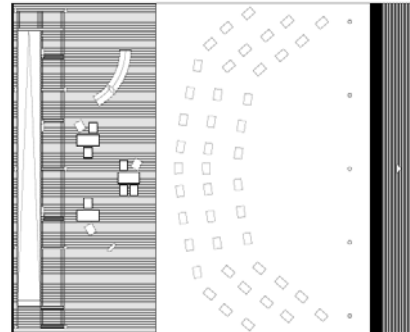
Planta do piso térreo do pavilhão proposto (esquema de palestra).
